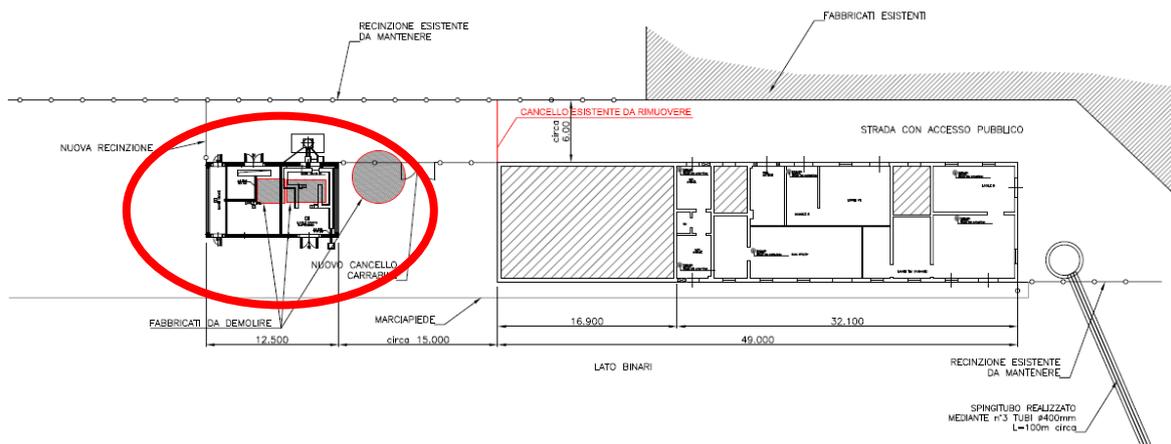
Cerchiata in rosso la localizzazione planimetrica del fabbricato
